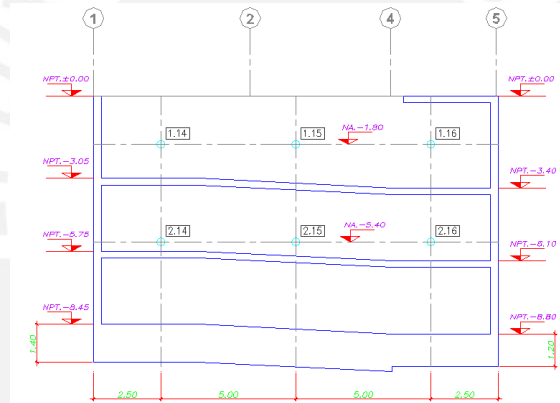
Muro Anclado - Detalle de Ubicación de Anclajes en “Eje A”.
